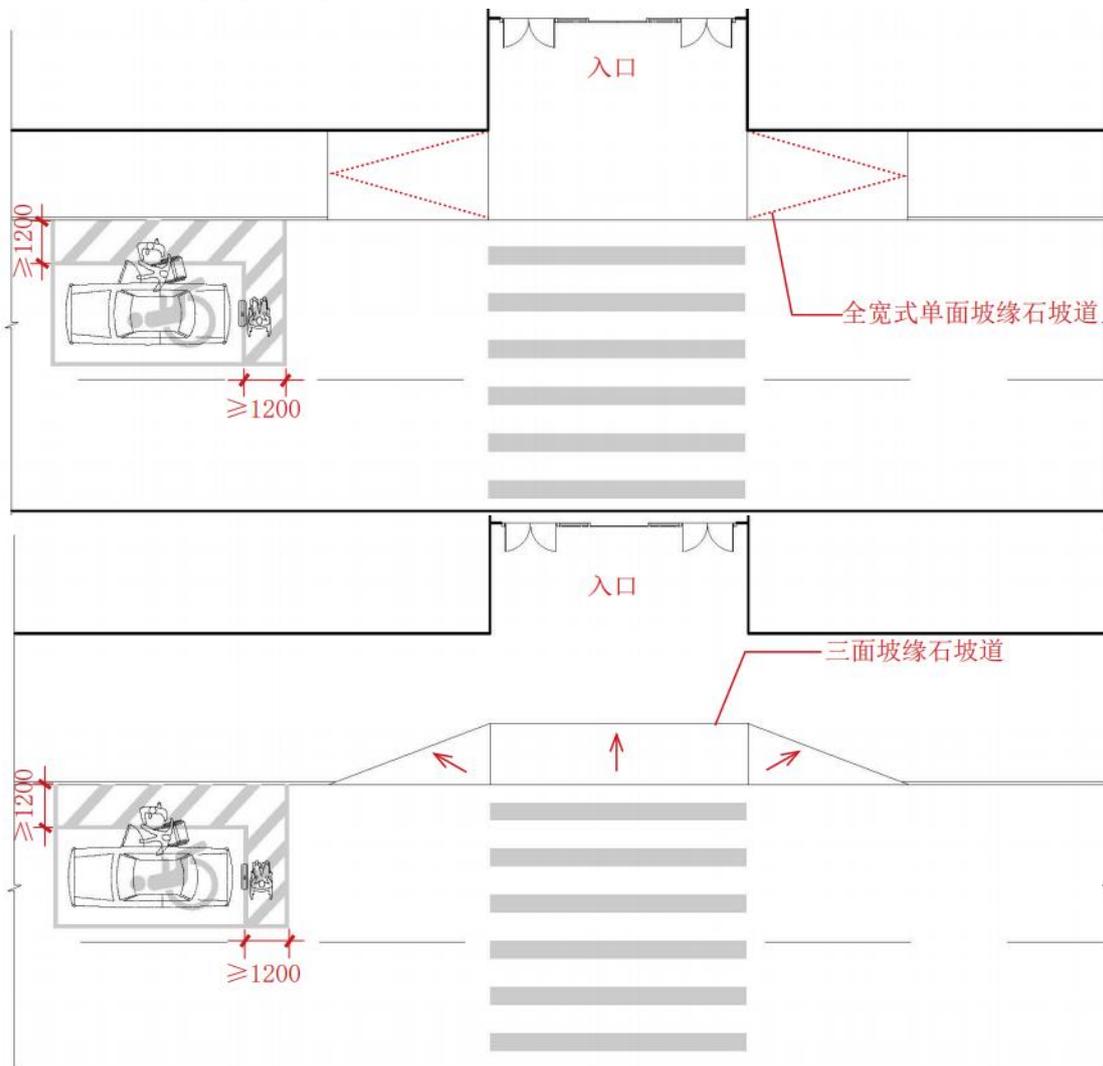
旅客落客区无障碍机动车停车位示意图（单位：mm）
